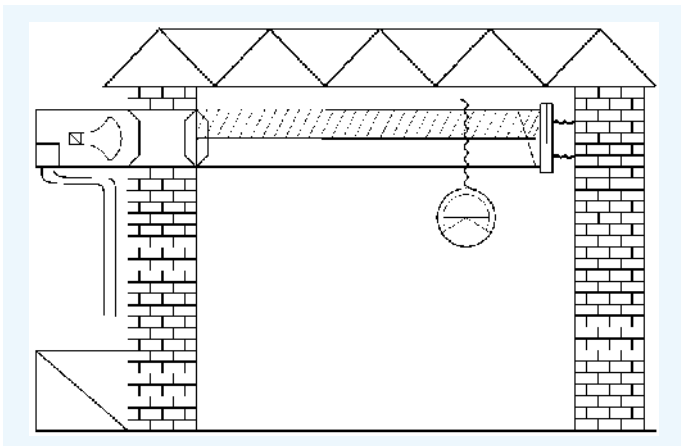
Схема осветительной установки со световодом для специальных условий применения
